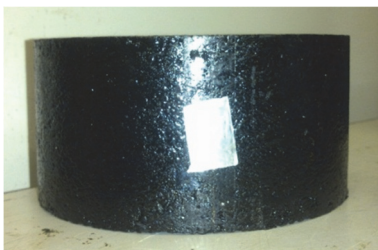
Echantillon PCG avec pastille (hauteur 75 mm, diamètre 150 mm)
